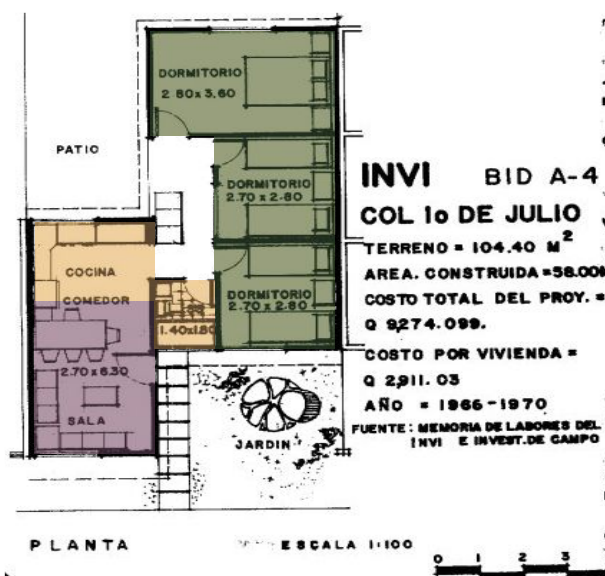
| Zonificación y planta arquitectónica de vivienda sin local comercial. Fuente: Elaboración propia.
